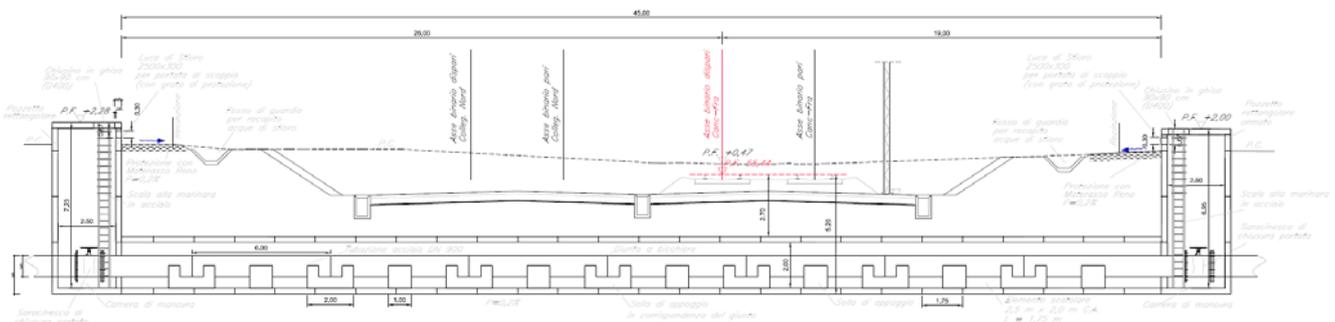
Sezione longitudinale e individuazione delle sezioni SC1 oggetto di verifica.
